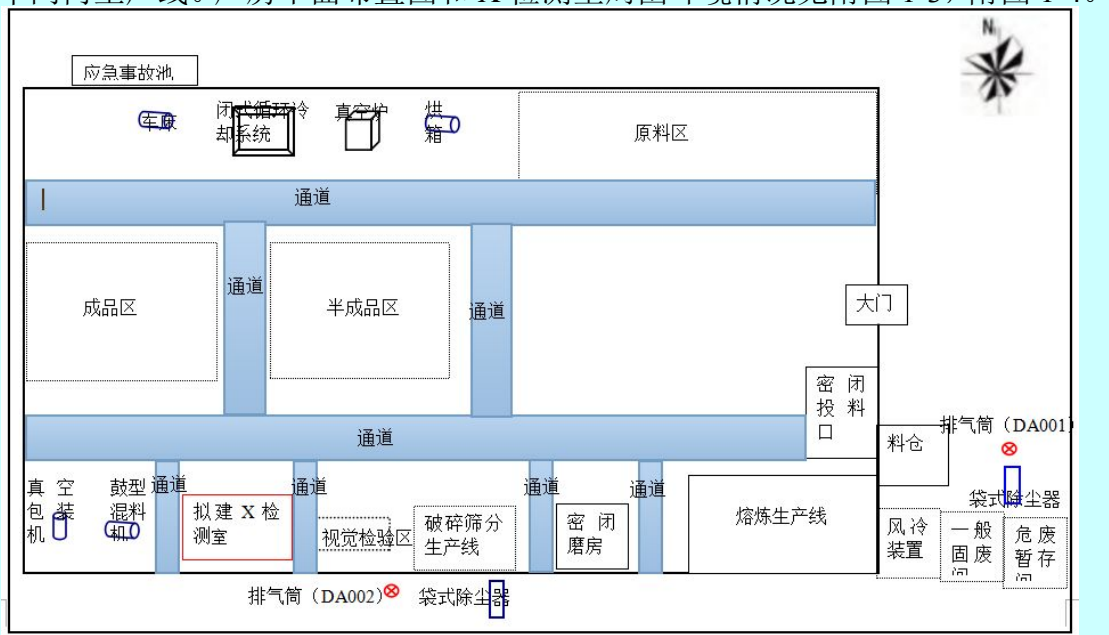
河南邦立德特种合金材料有限公司厂房平面布置图
